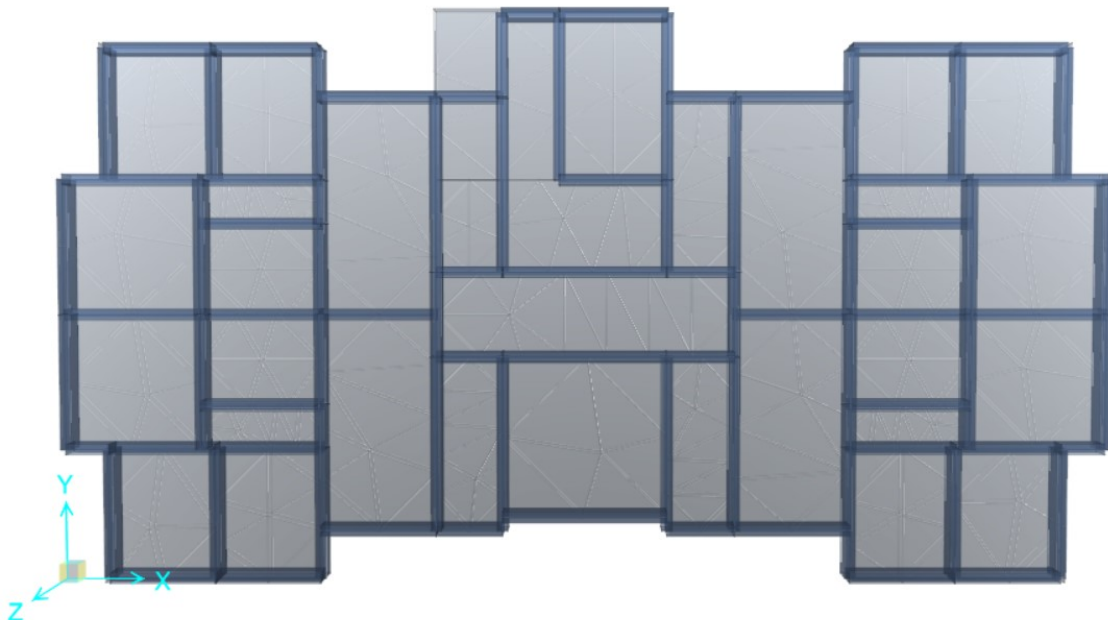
Disposición de elementos estructurales en la cimentación (Vista Planta) Sistema MDL - Edificio Blesser. Fuente: Elaboración Propia.
